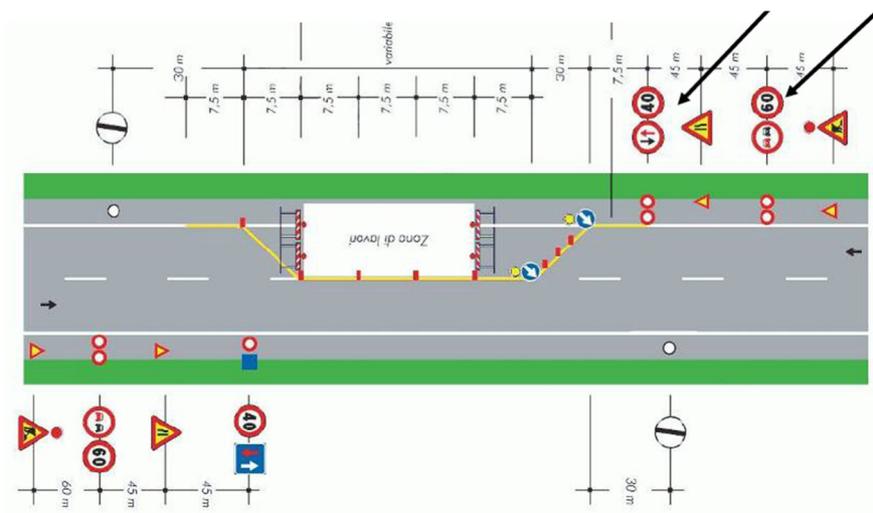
Esempio cantiere stradale con limitazione della velocità con senso unico alternato a vista
